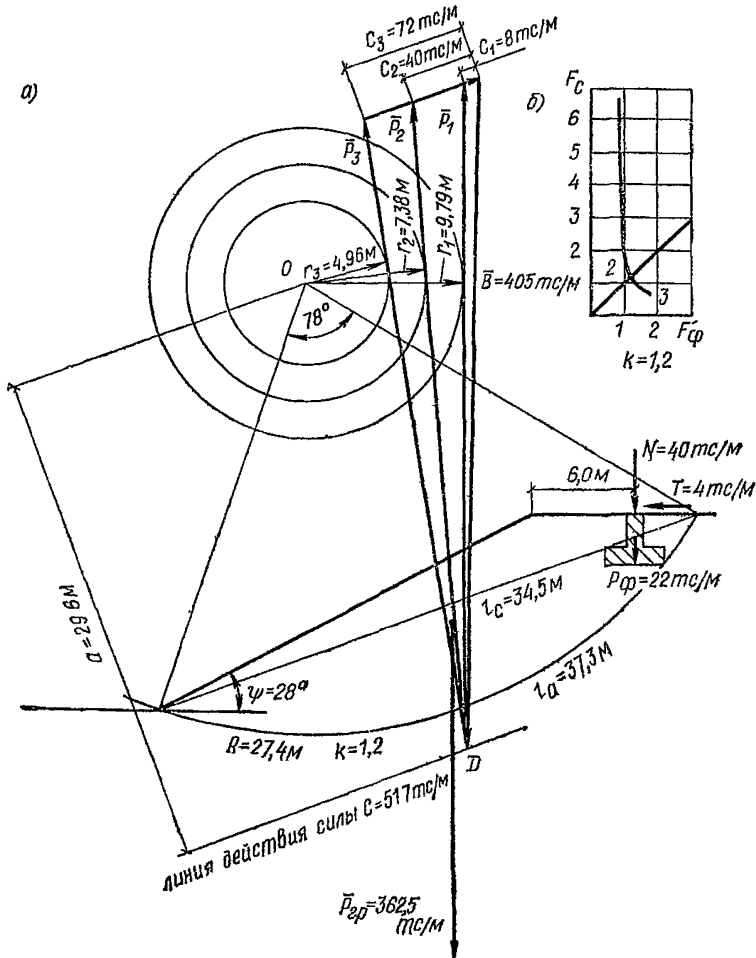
Определение окончательных размеров фундамента по способу «круга трения»
